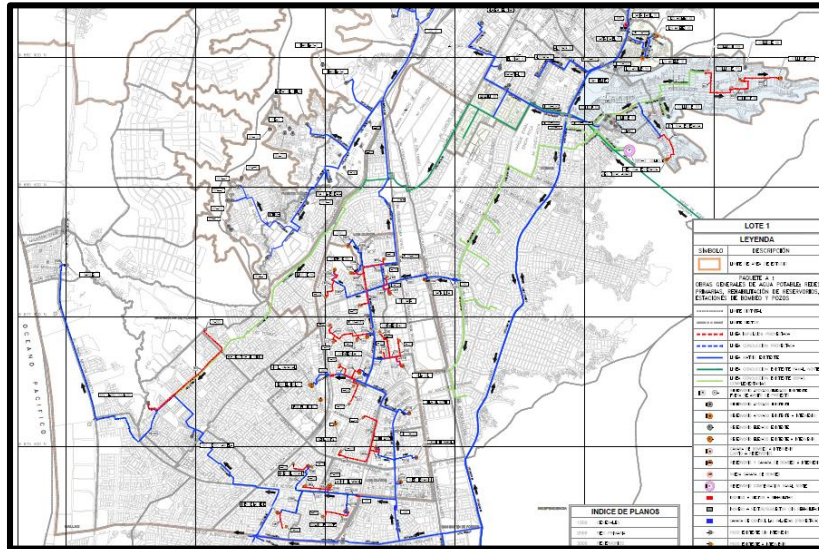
Ubicación de las obras generales del proyecto Lima Norte II Lote 1
